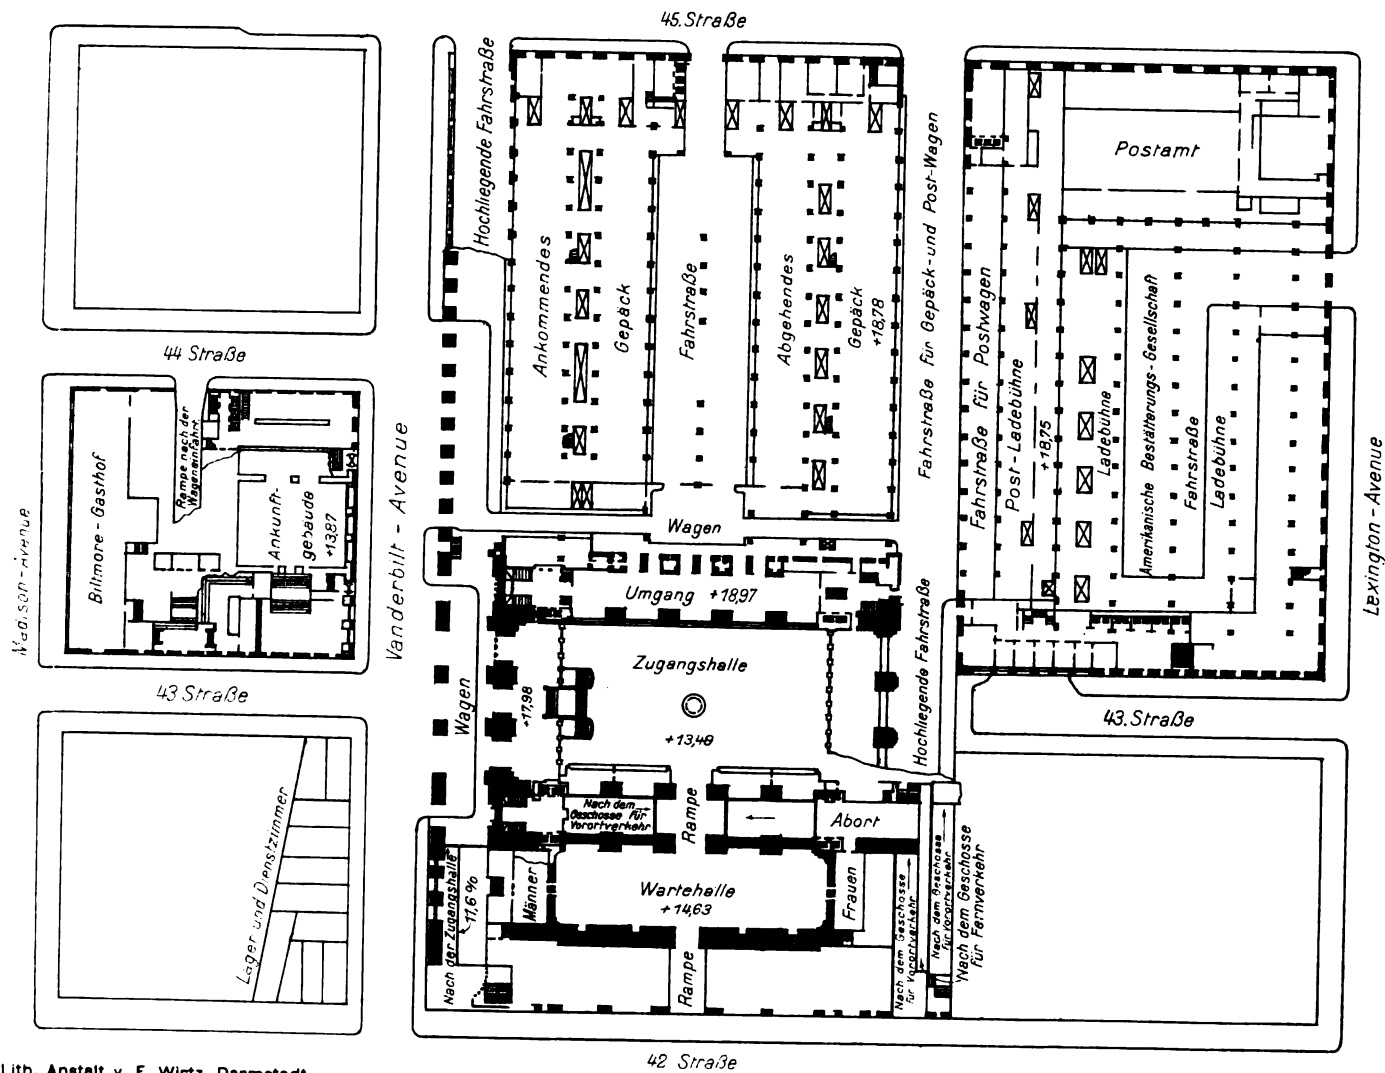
Grundriß in Höhe der Straße und des Gepäckraumes.
